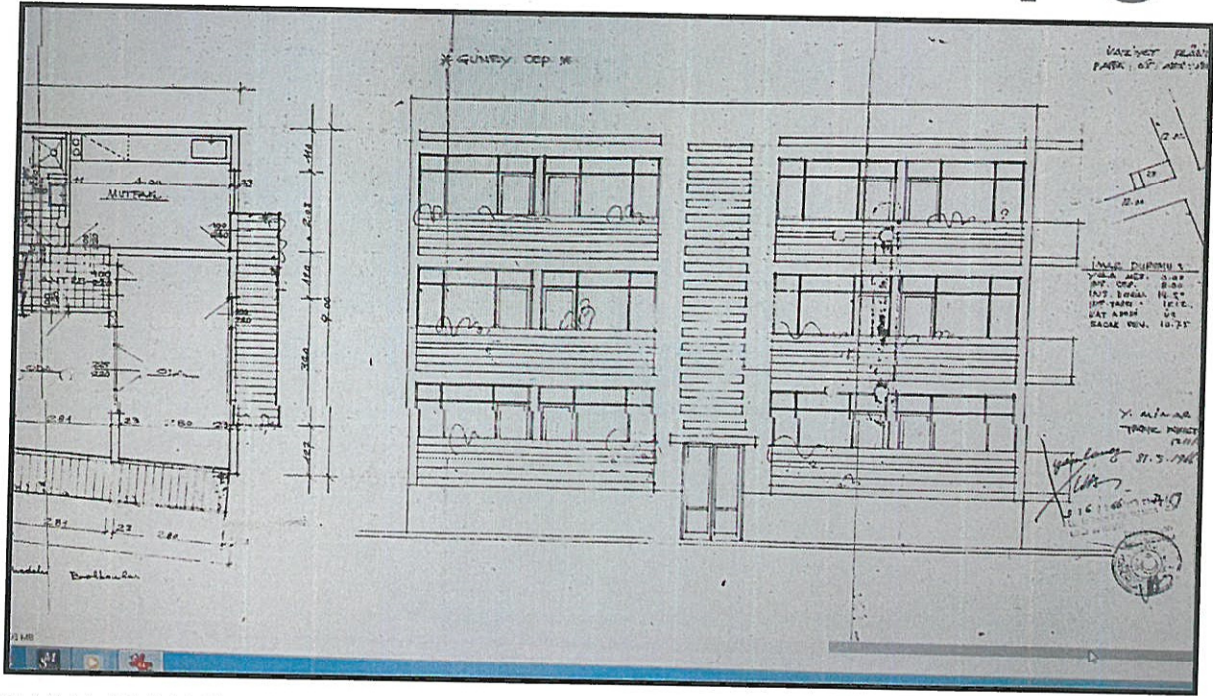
31.5.1966 tarihli onaylanan vaziyet planı
